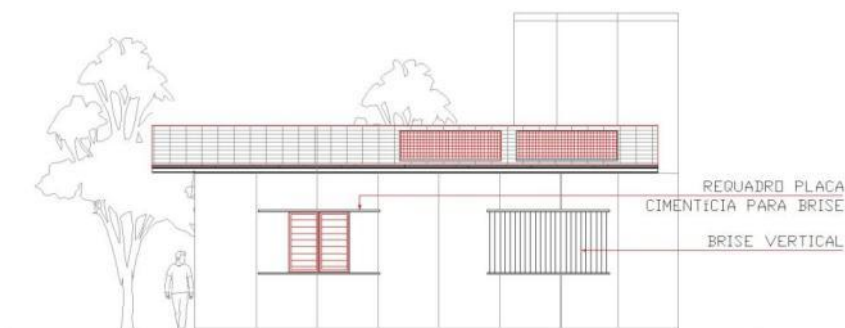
Vista do protótipo com esquema proposto para elementos de proteção solar.
